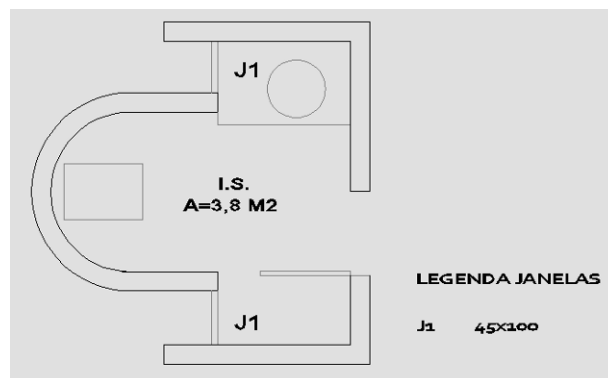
Planta banheiro pavimento térreo – indicação de áreas de aberturas.
